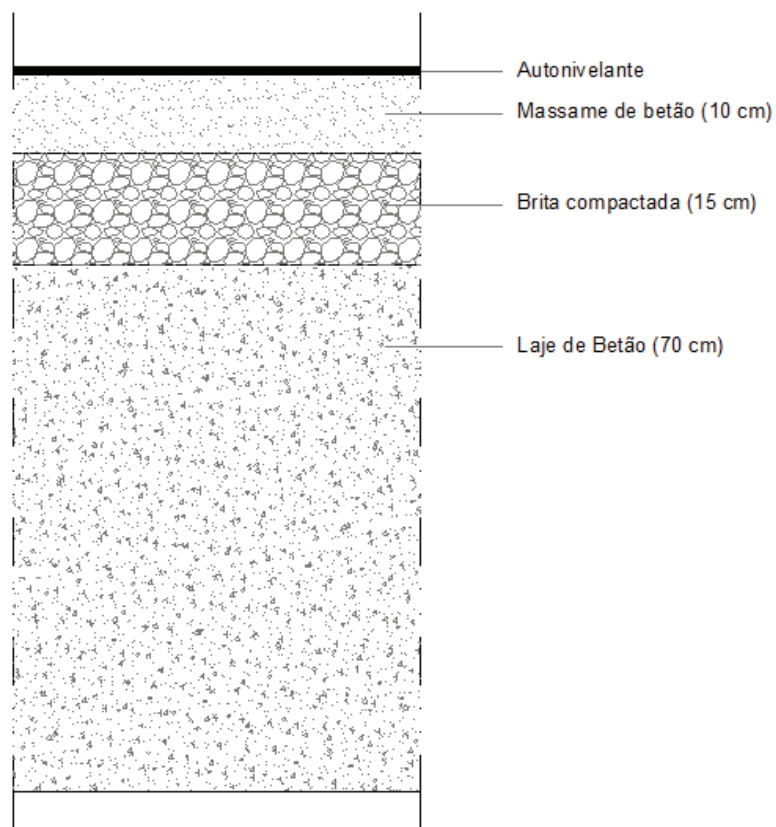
Pormenor construtivo do pavimento interior tipo I (cota 4.10)
